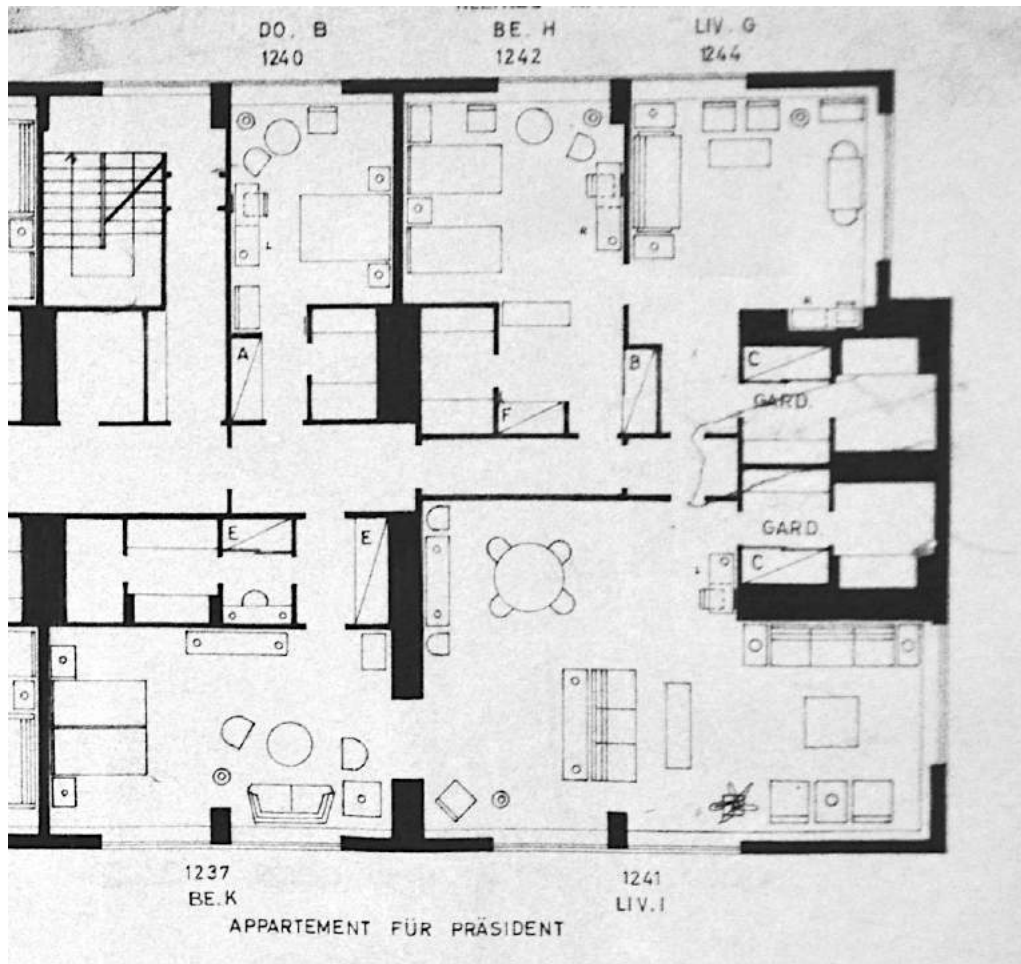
Grundriss Präsidentensuite im 12. Stock,
